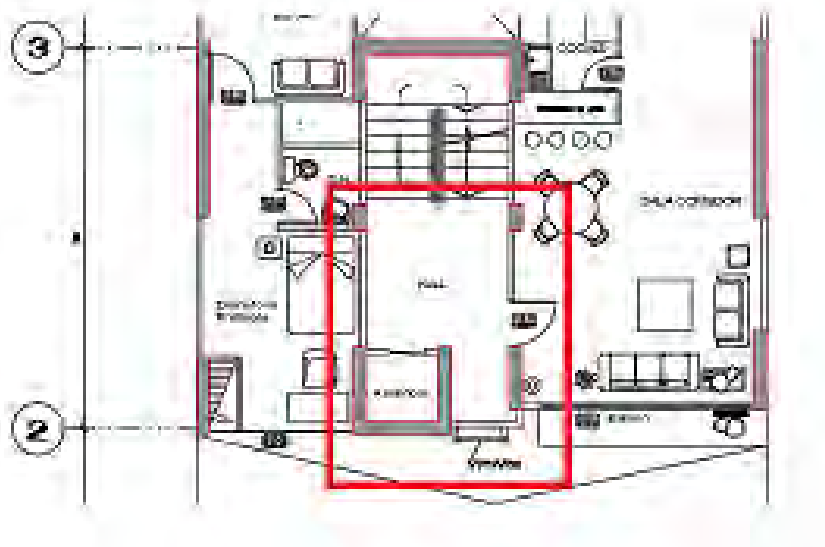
Acercamiento a los ejes 2-3 y B-C en el plano de arquitectura
